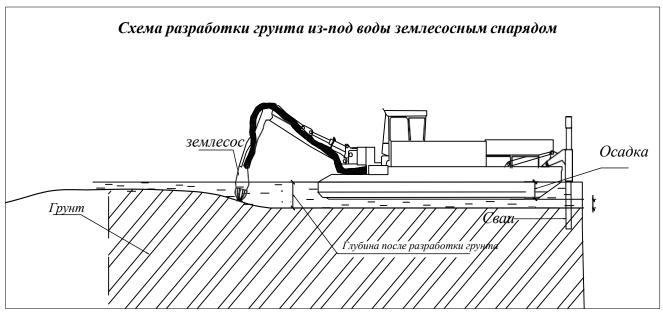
Схема разработки грунта из-под воды землесосным снарядом
